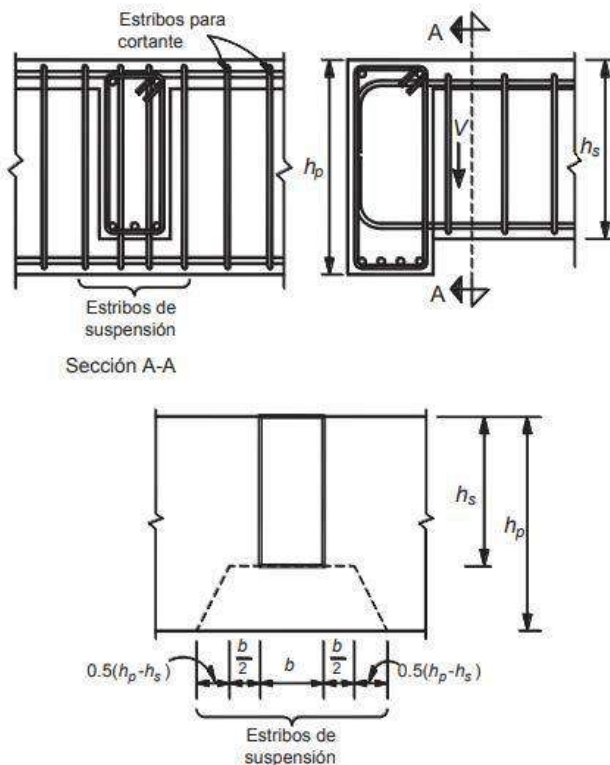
Transmisión de fuerzas y conexión entre vigas secundarias y principales
